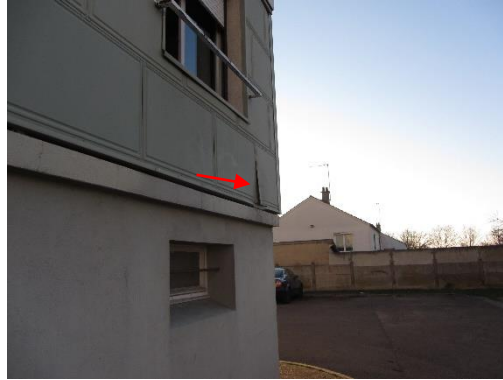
Joints de dilatation au niveau de l'avancée de toit (façades est et ouest)
